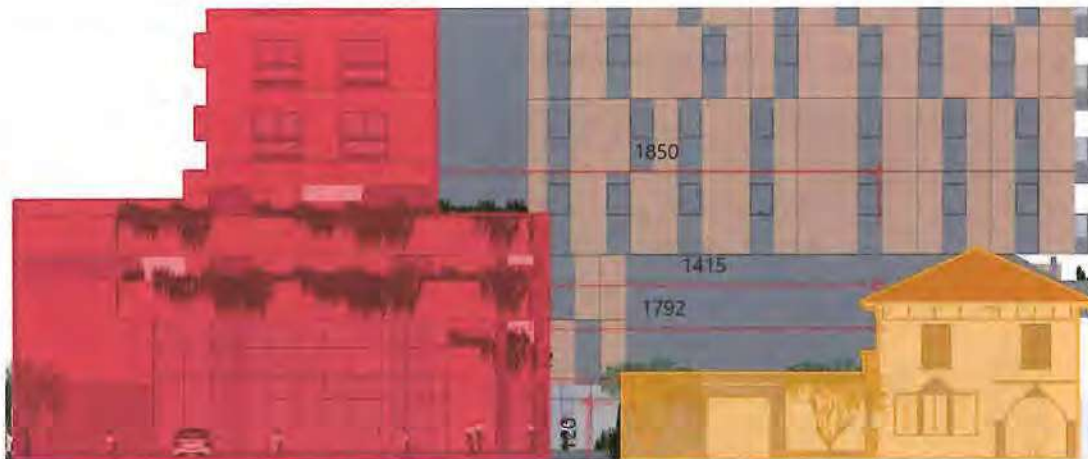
Elevação frontal (em amarelo, edificação protegida; em vermelho, edificação proposta). Fonte: Halsten, 2026. Adaptado.
